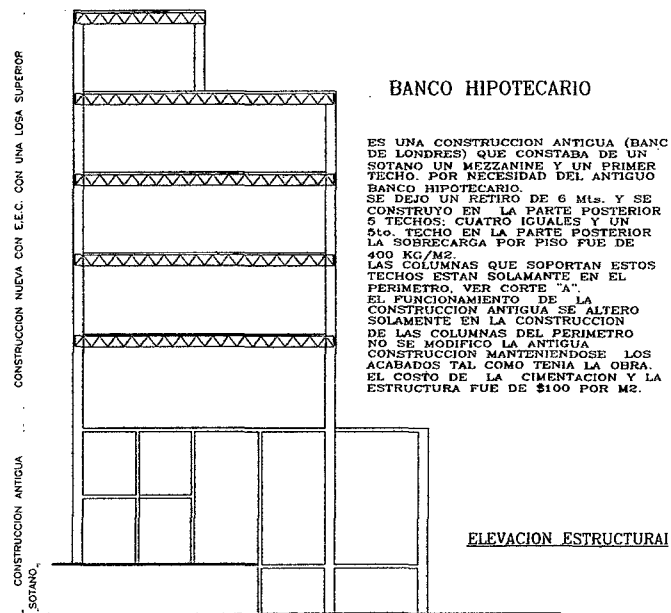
Plano en planta de un edificio remodelado y ampliado con EEC .
